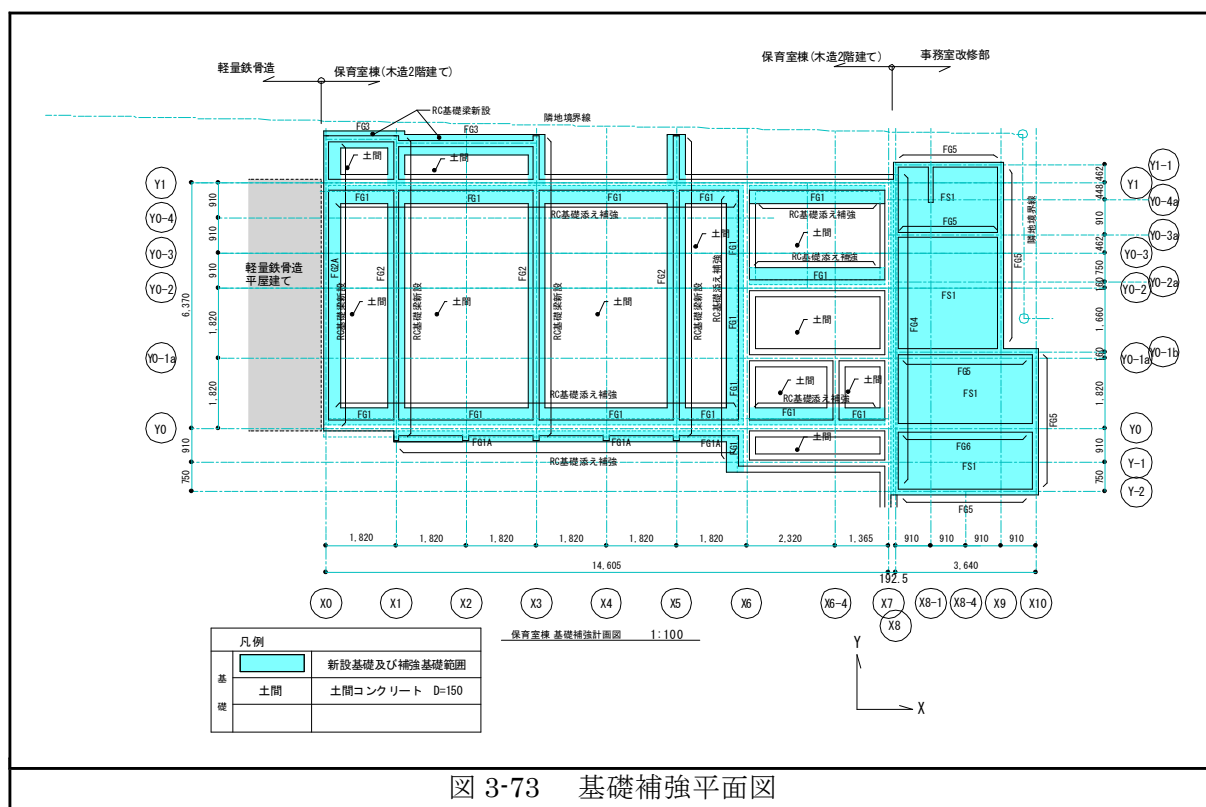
は基礎の補強計画図である。基礎の補強は既存基礎の補強と鉄筋コンクリート基礎の新設になる。既存基礎補強は X 方向の桁行き構面(図 3-73 の Y0 通り, Y1 通り)そして Y 方向は保育室と玄関ホールとの戸境壁(X6 通り)と改築平屋部分との境界壁(X7 通り)が中心になる。補強方法は図 3-74 に示すように、あと施工アンカー(樹脂系)を既存基礎の側面に設置し鉄筋コンクリート基礎を沿わせるかたちで補強する。これにより、既存無筋コンクリートの曲げ破壊及びせん断破壊への防止または抑制、そして基礎の一体化と上部構造から伝達されてくる力の処理が可能になると考える。
